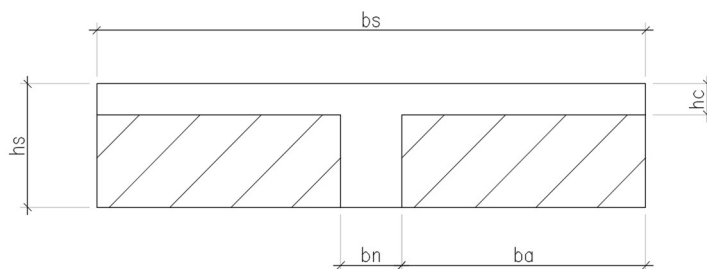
Sección de losa alivianada, (Elaboración propia).
